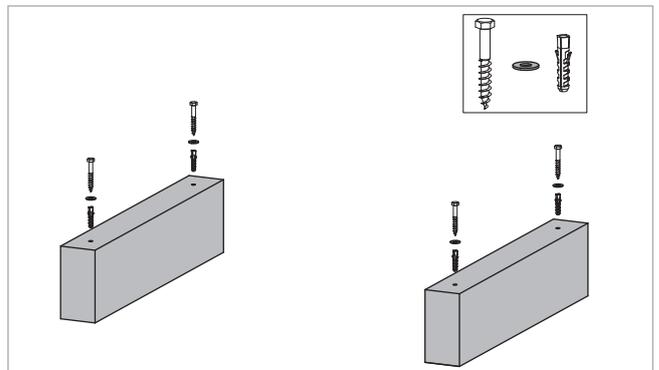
Dübel einsetzen sowie Scheiben auflegen und Schrauben einschrauben
